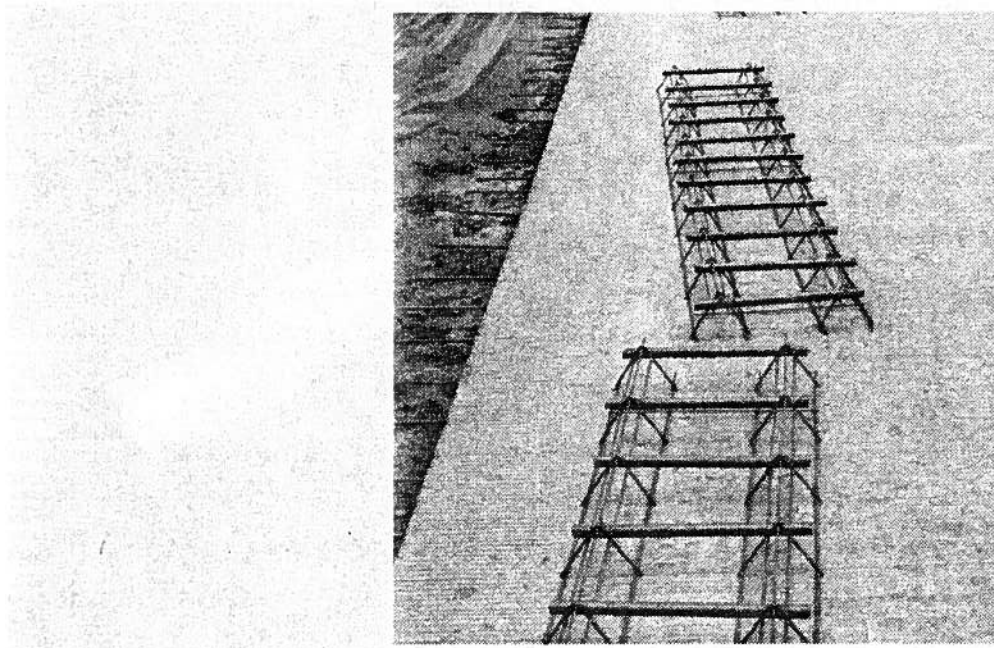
Guía de armaduras e introducción de aceros en las trompetas.
